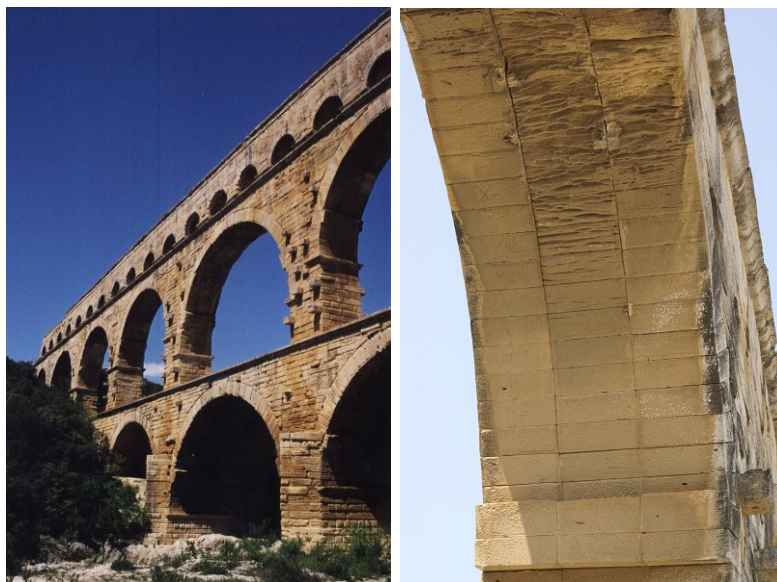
Pont du Gard (Photo : Nicolas Janberg, www.structurae.de) [2.3]
